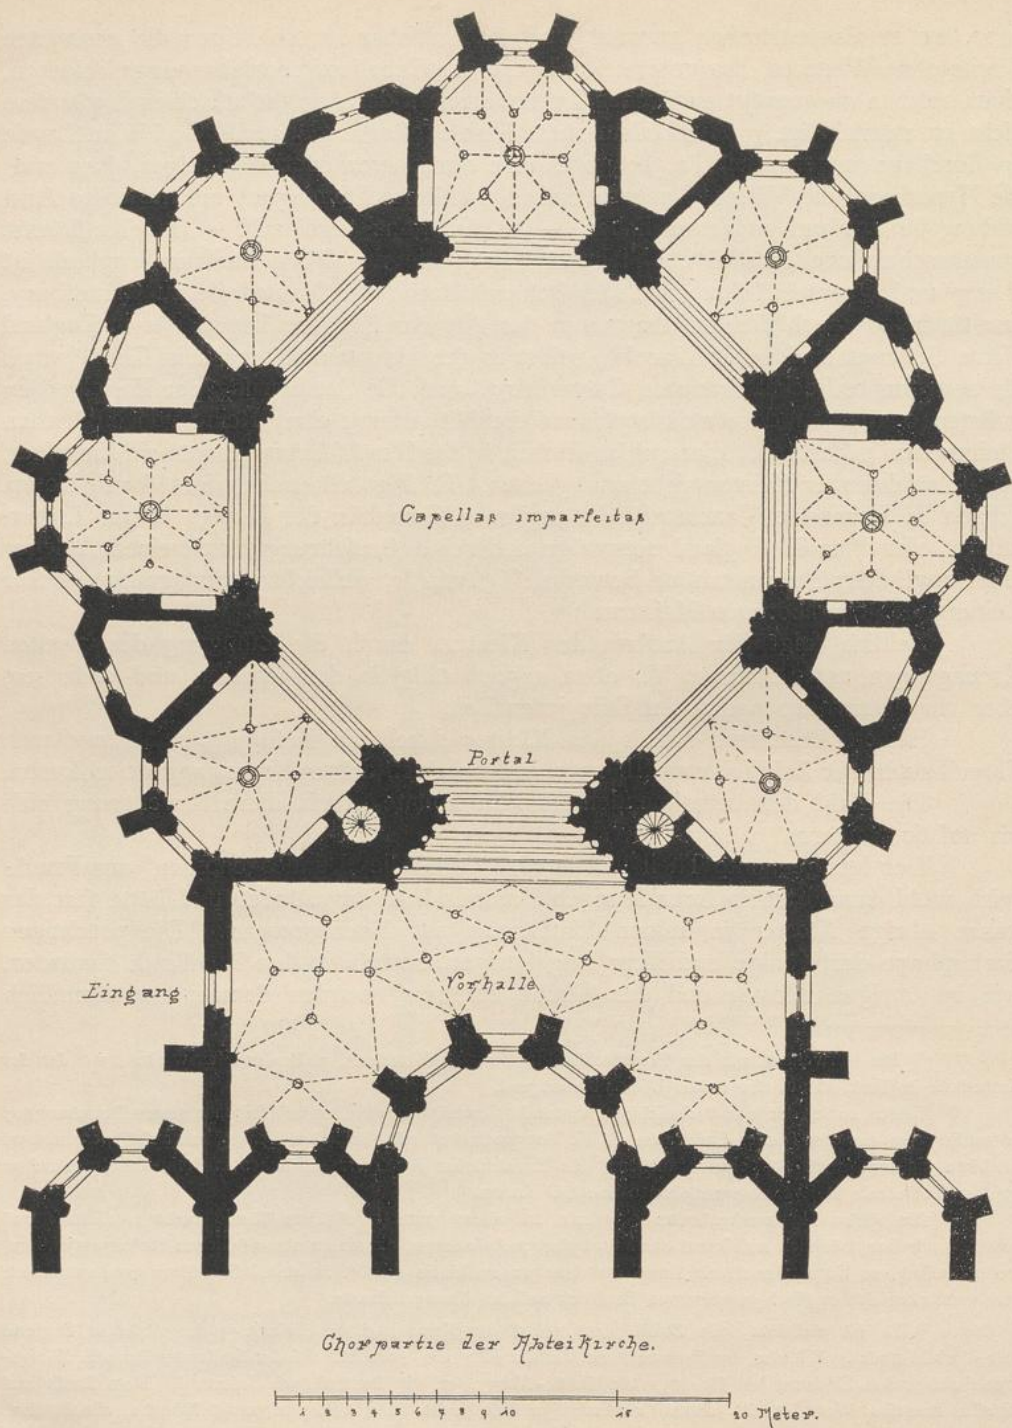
Grundriss der Capella imparfeita zu Batalha.
